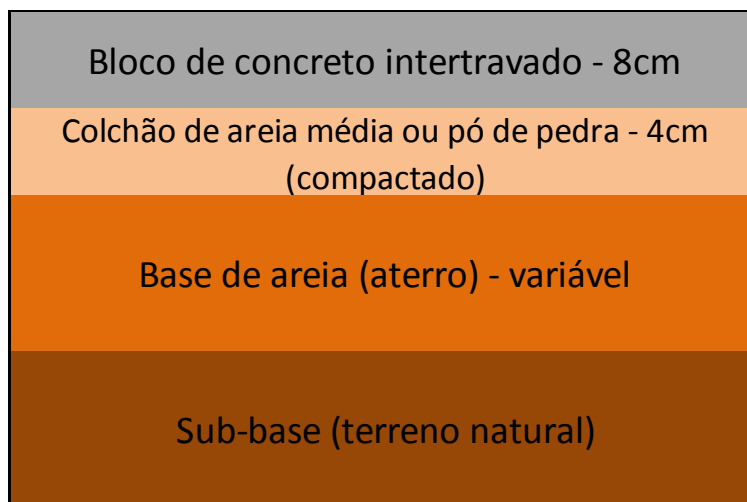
Camadas do pavimento de bloco de concreto intertravado
